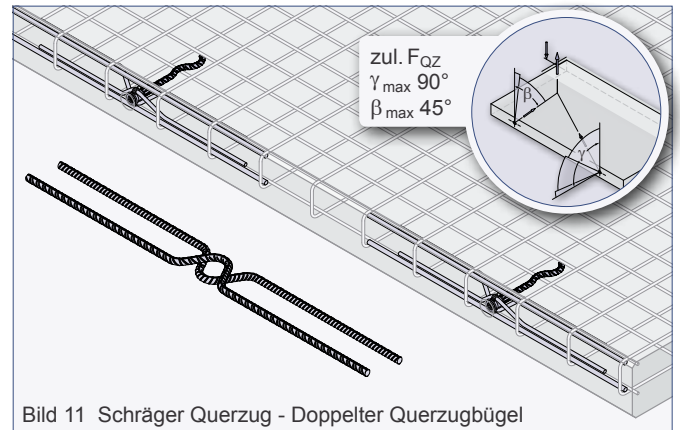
Schräger Querzug - Doppelter Querzugbügel
